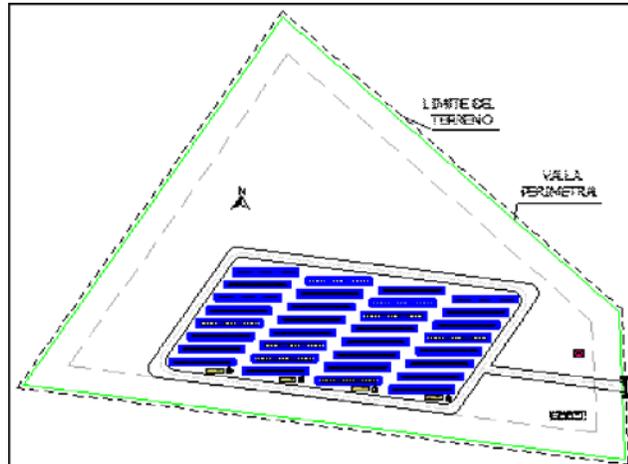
Ejemplo Disposición de la Planta Solar (400 kW)
